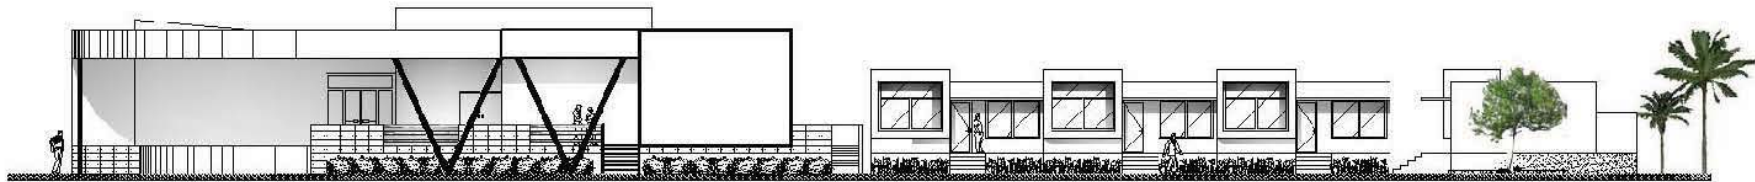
Fachada de conjunto. se observa la fachada sur del edificio y las casas que se construirán para el personal que trabajan en la institución, las fachadas se proponen con el mismo lenguaje que el edificio de oficinas a través del uso de marcos que brindan sombra a los vanos de las ventanas.
